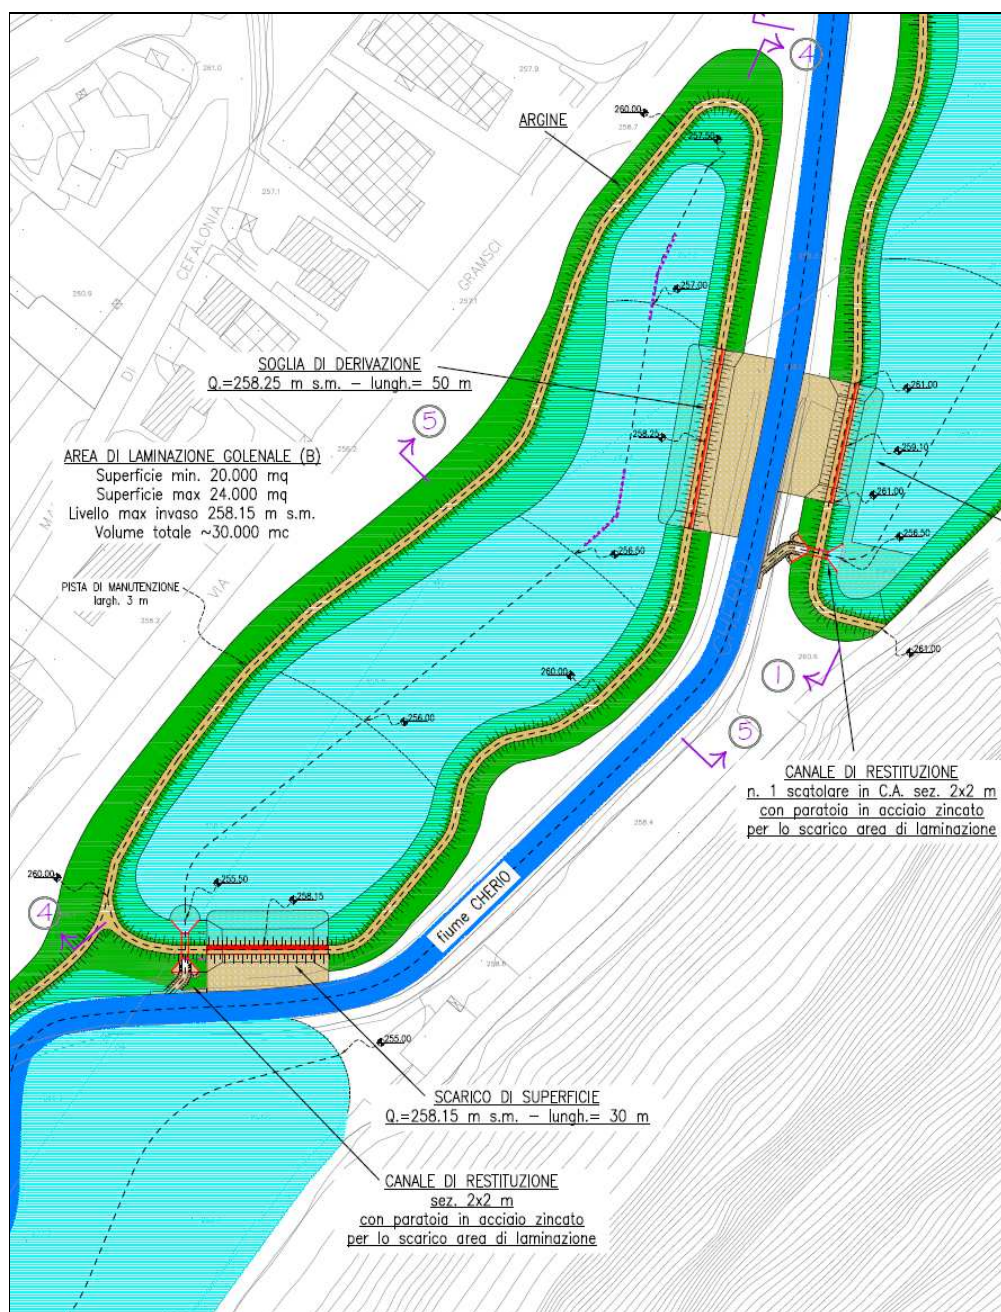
Planimetria dell'area di laminazione golenale "Brignoli"
